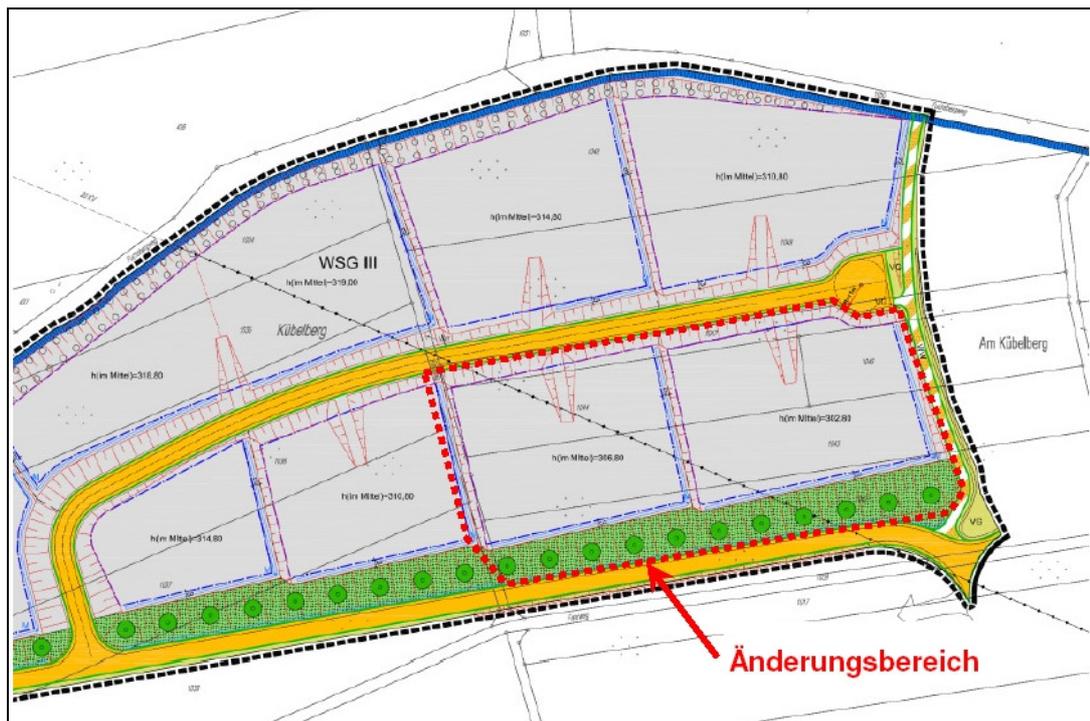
Abgrenzung des Änderungsbereichs der zeichnerischen Planänderungen
